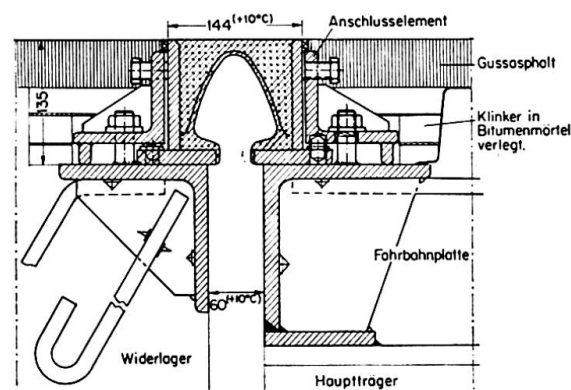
Anschluß des Fahrbahnüberganges an die Unterkonstruktion.
